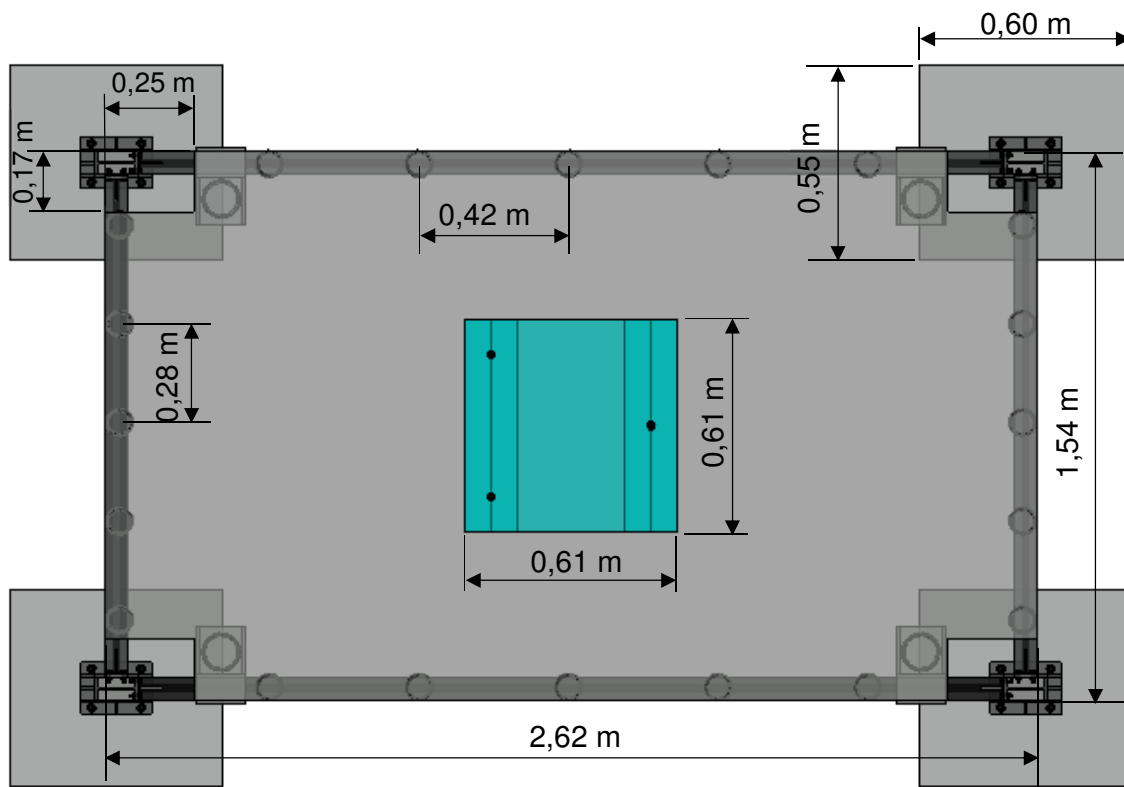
Modelo estrutural do piso flexível: Vista superior
